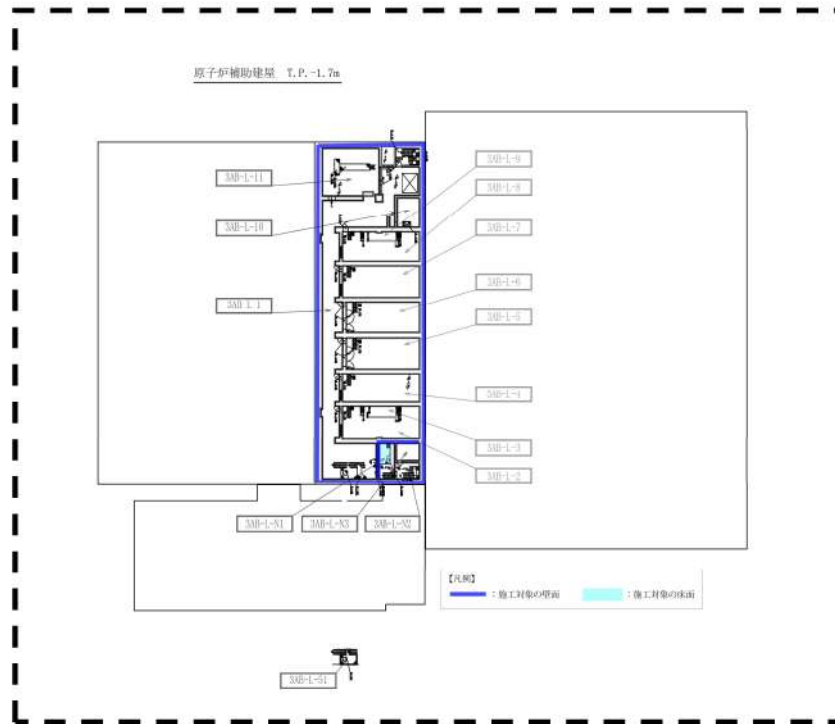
溢水防護対策施工対象の壁及び床の配置図 (10/11)
